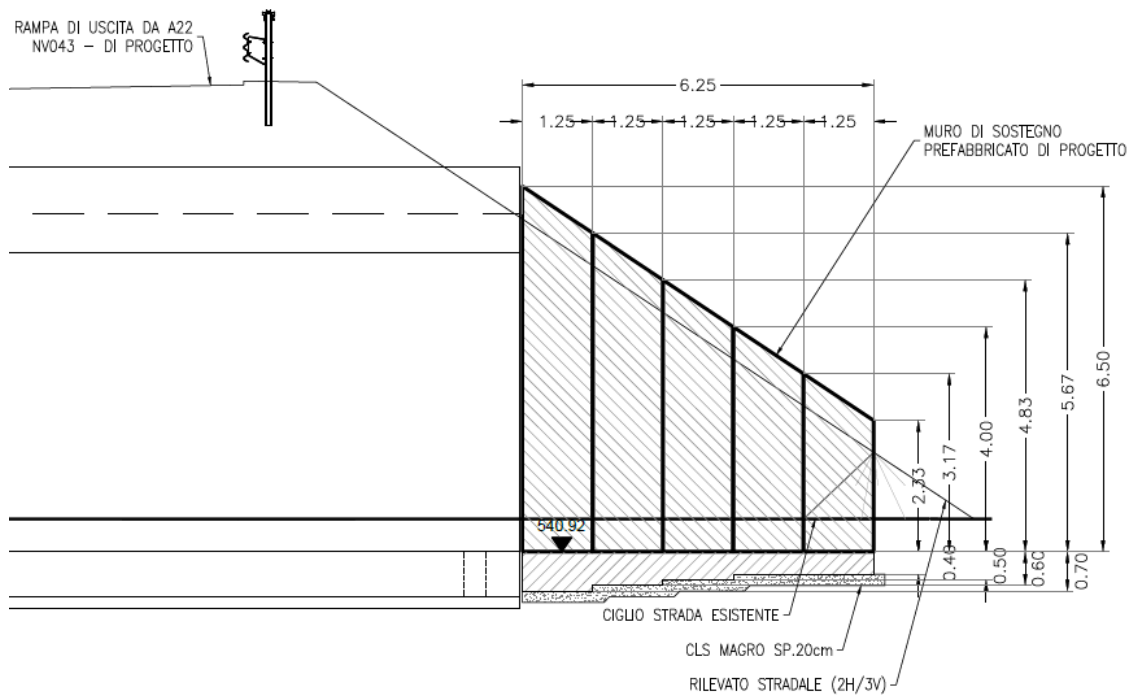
Prospetto (Muro Sud – Ovest), nuovo scatolare sulla strada provinciale SP27
